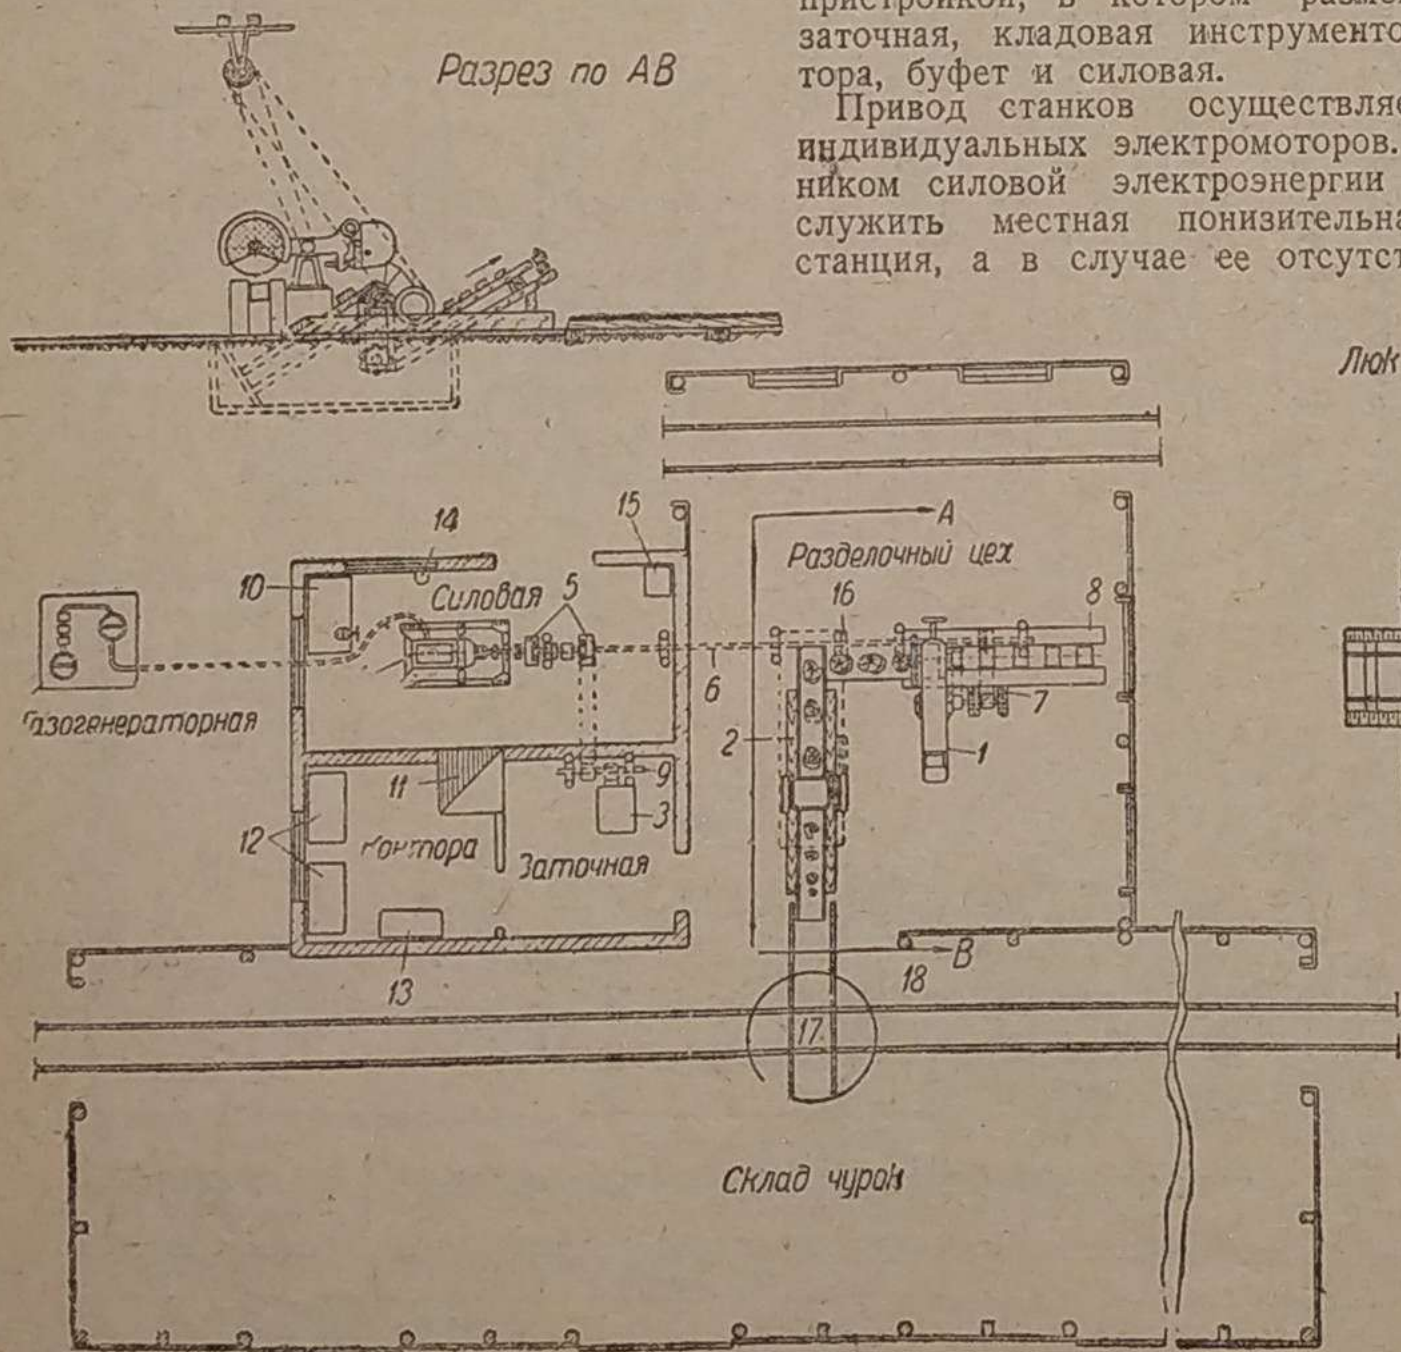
План разделочного цеха: 1 — балансирующая пила ЦБ-3, 2 — роторный колун КГР, 3 — заточный станок Тч-ПН, 4 — двигатель внутреннего сгорания, 5 — контрпривод от двигателя, 6 — трансмиссия, 7 — контрпривод балансирующей пилы, 8 — рольганг, 9 — контрпривод заточного станка, 10 — верстак слесарный с тисками, 11 — печь для отопления, 12 — конторский стол, 13 — шкаф, 14 — бак для бензина, 15 — шкаф для одежды, 16 — лоток, 17 — поворотный круг, 18 — узкоколейка.
